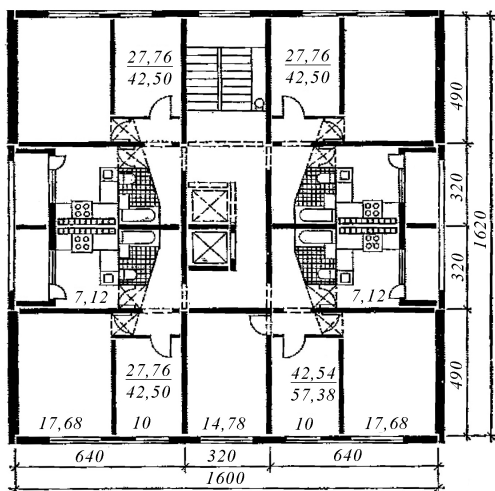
Фрагмент плана типового этажа 9-этажной башни
